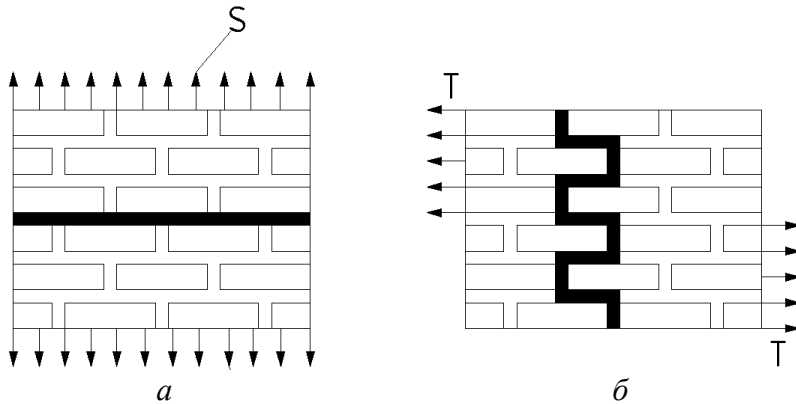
Схеми руйнування розтягнутої кладки: *a* – за непере́в'язаним швом; *б* – за пере́в'язаним швом
